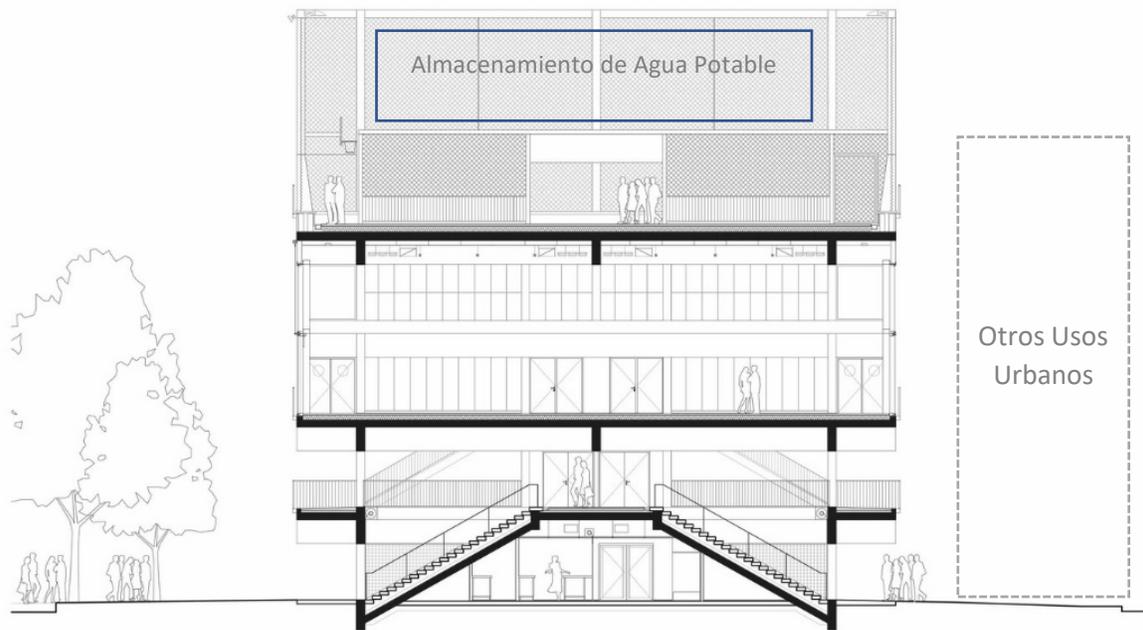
Modelo arquitectónico para edificio + Tanque elevado (Fuente: <https://www.archdaily.co> ²)
